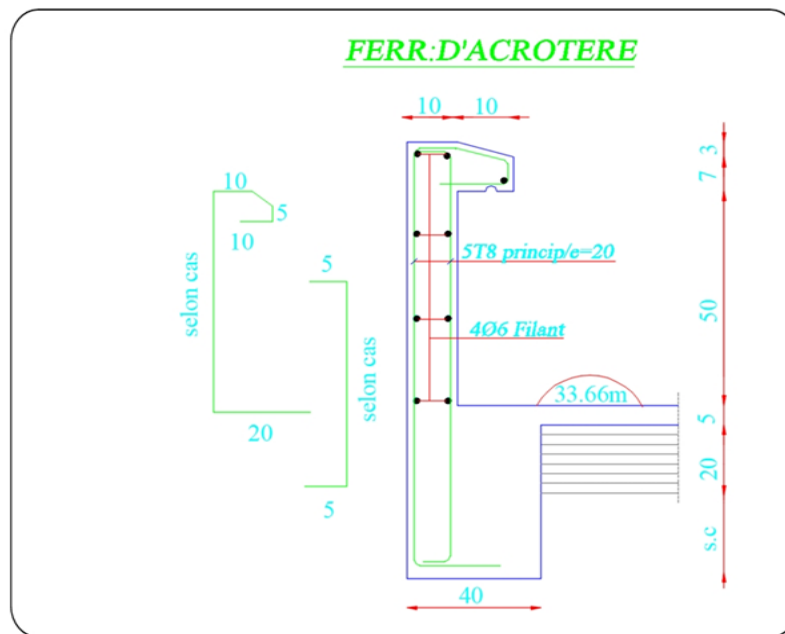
Schéma de ferrailage de l'acrotère.
